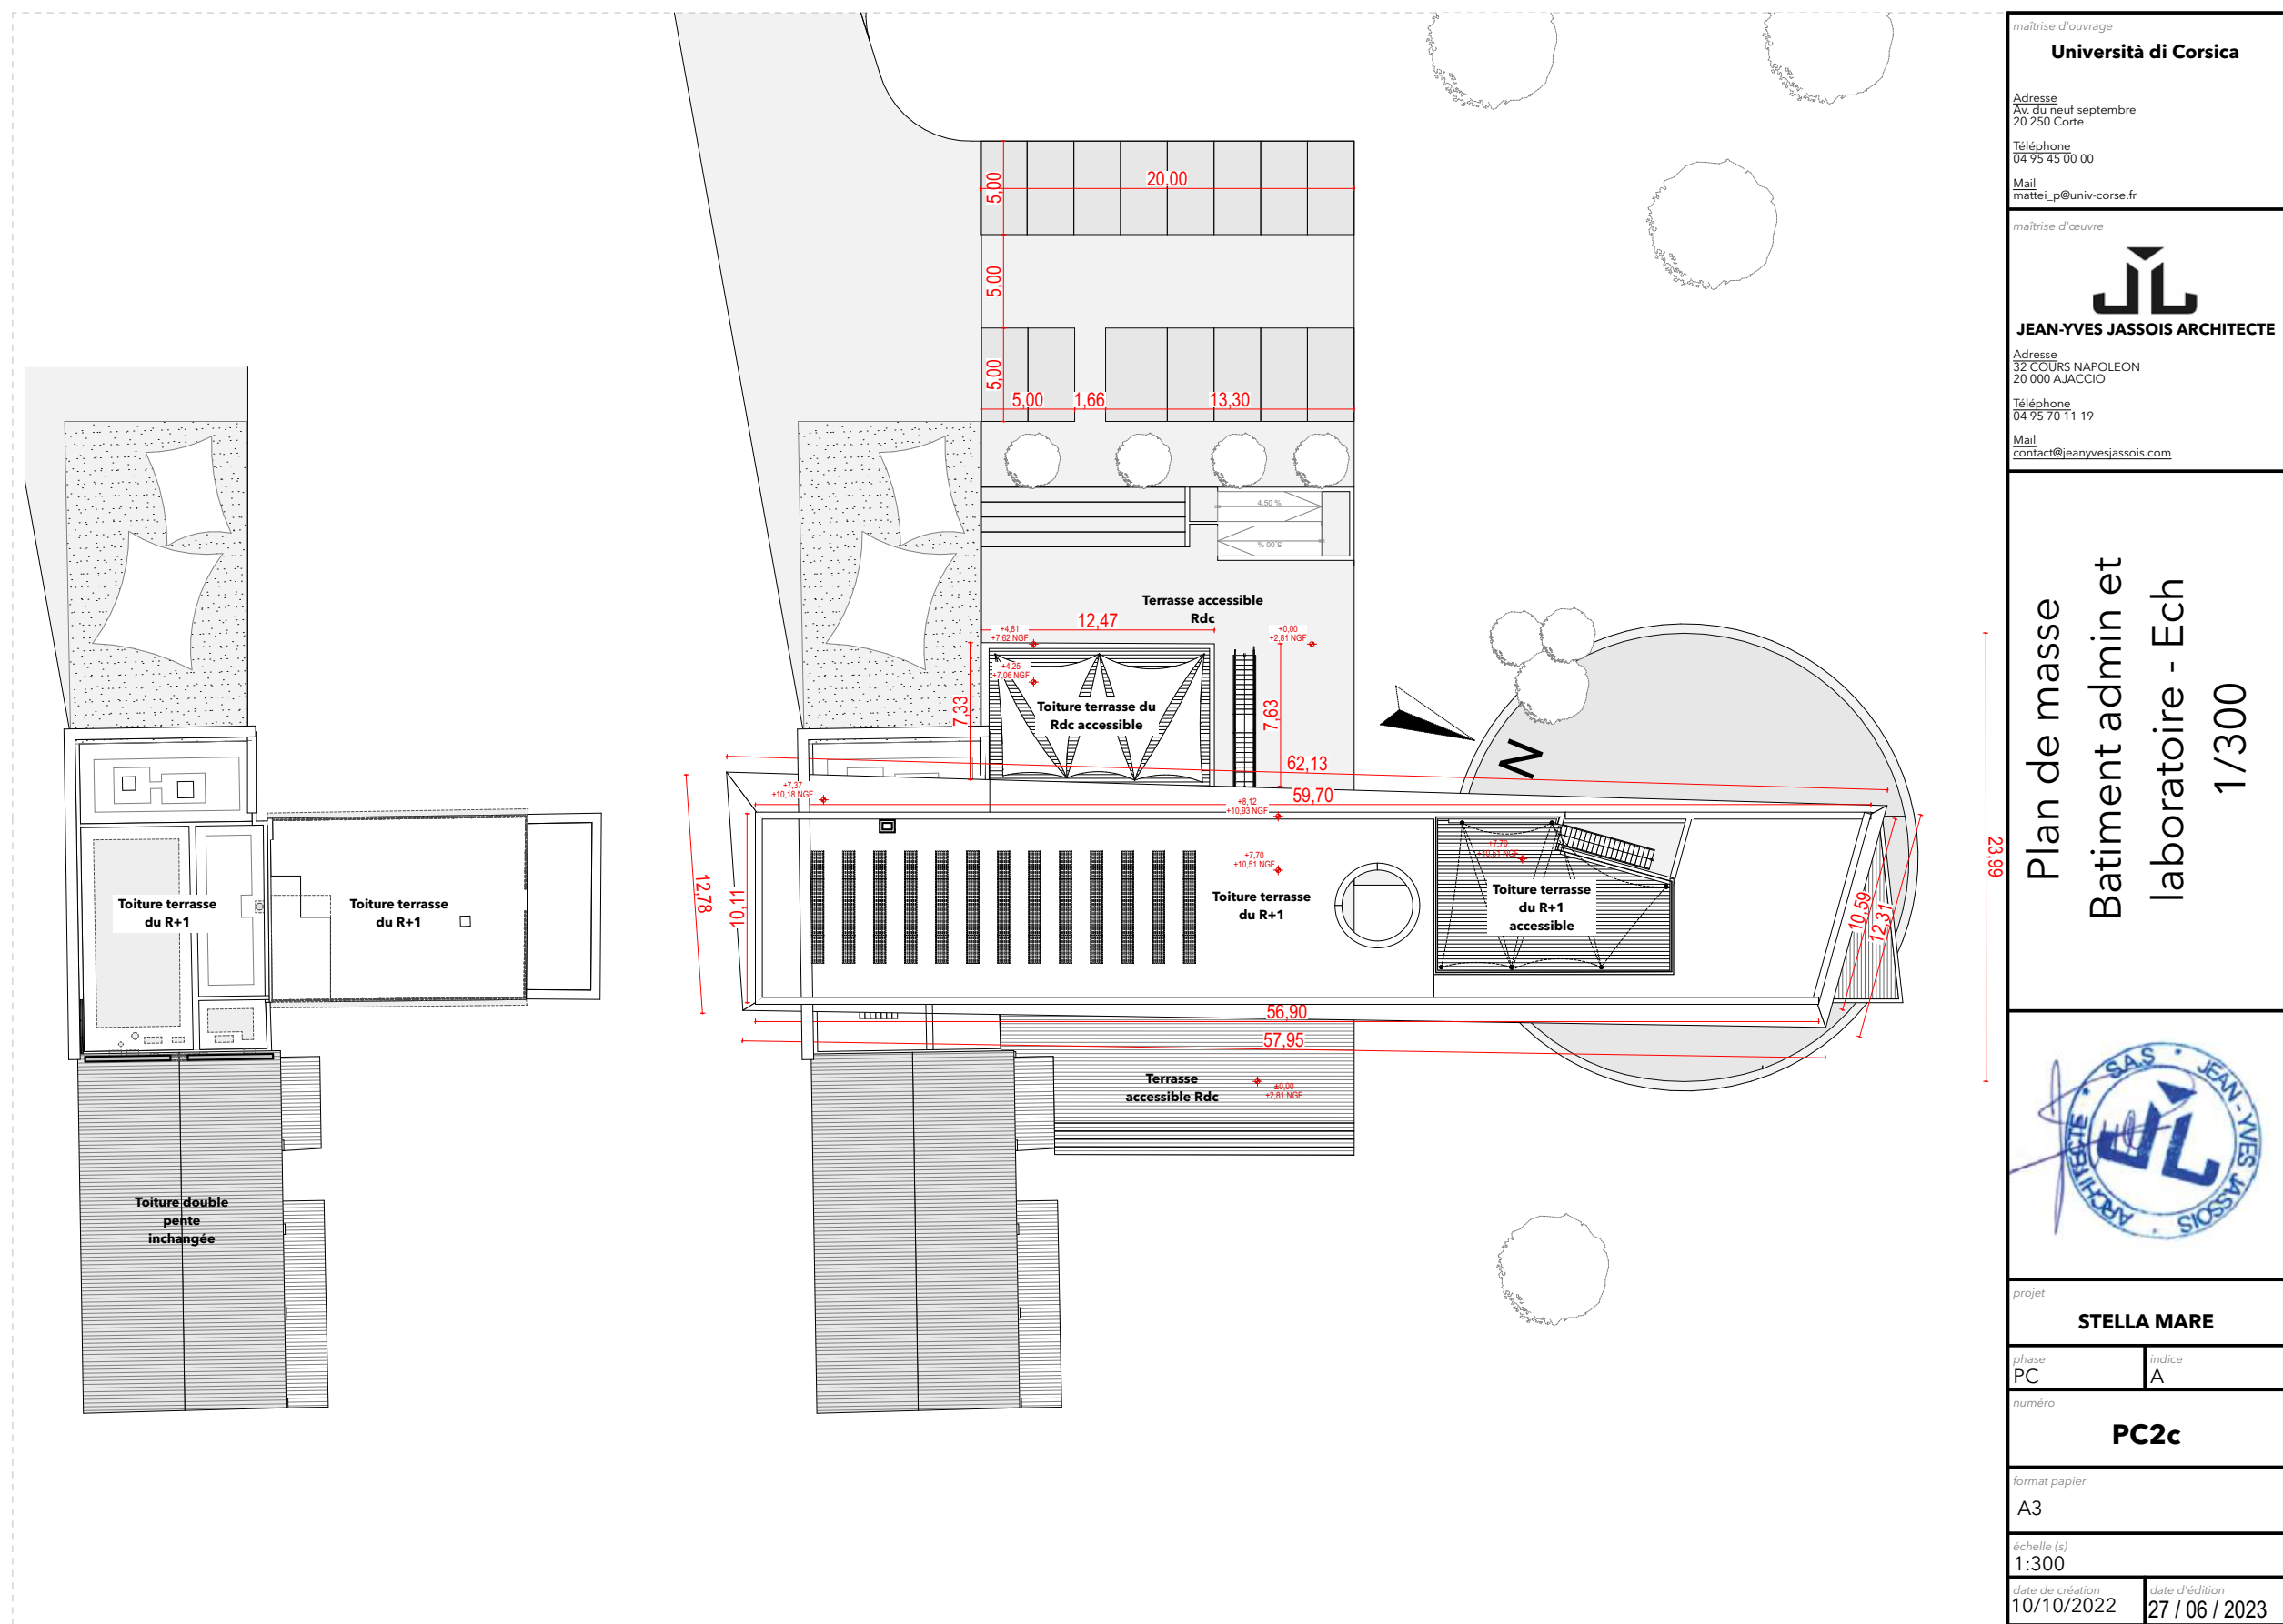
Plan de masse du projet (Source : Jean-Yves Jassois Architecte)
